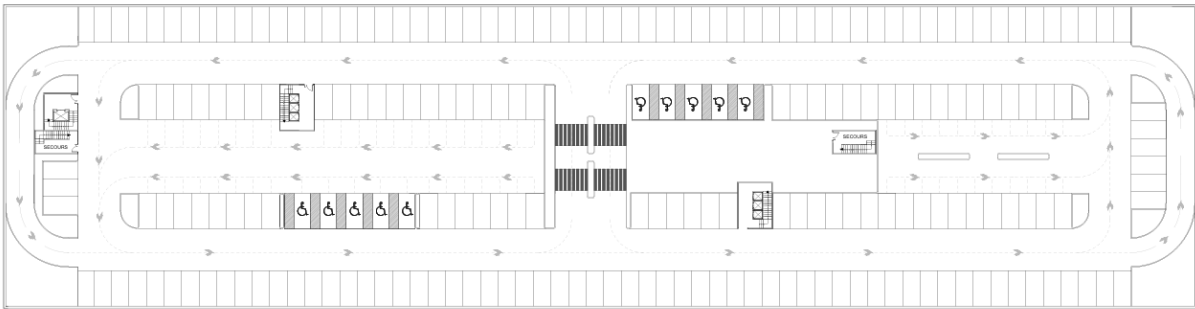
Plan sous-sol (Parking) -5.40m/-8.10m (Source : L'auteure)
